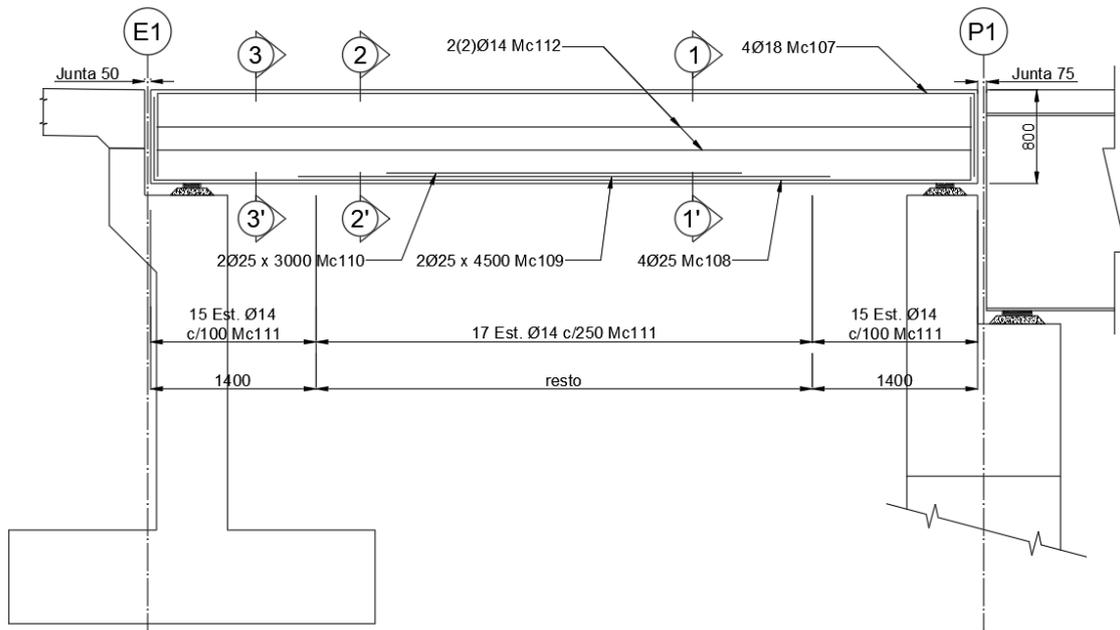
Elevación longitudinal de la viga de H.A.(P2-E2) [Elaboración propia]
